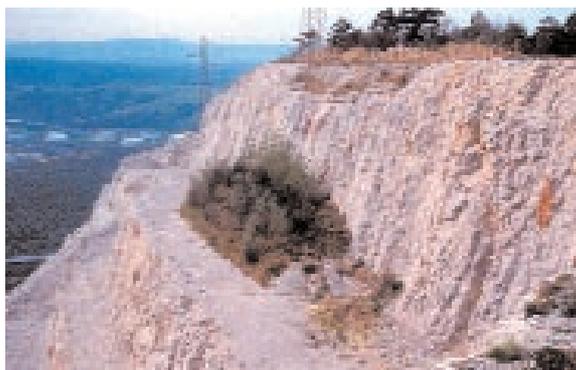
Cava Scoria, lavori di recupero con rilevati rivegetati, campione di prova, settembre 1988
